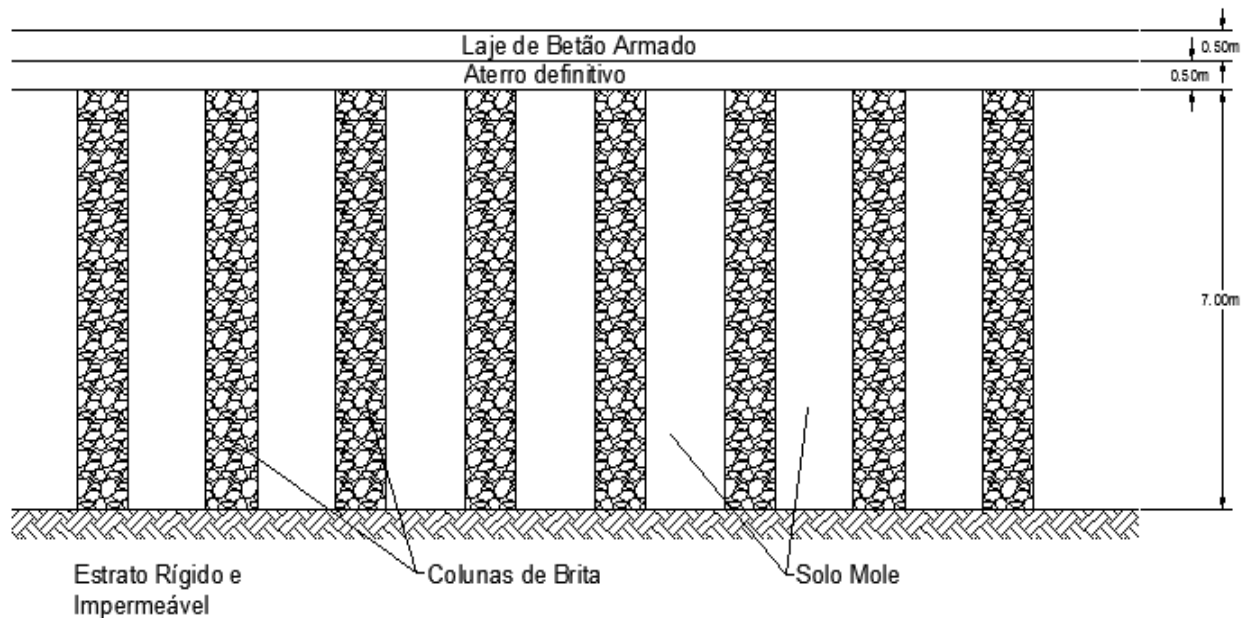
Representação esquemática da fase final do problema base, após retirada a pré-carga e executada a laje de fundo do reservatório.
